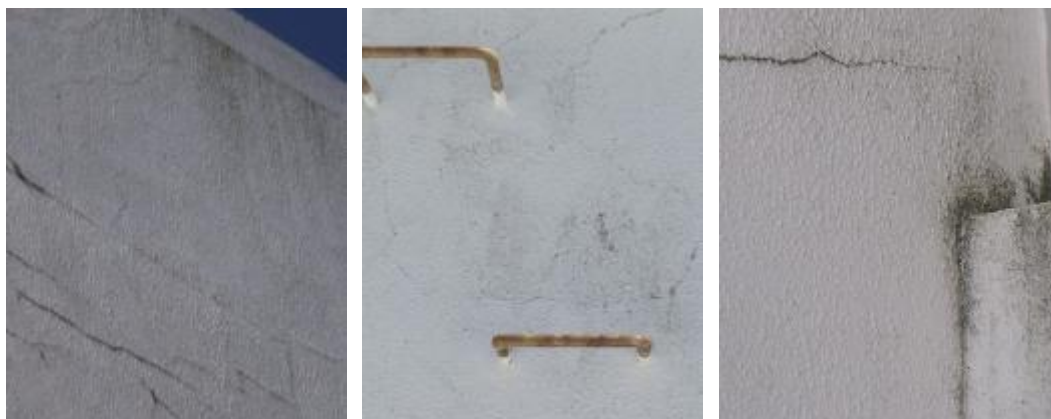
Fissuração diversa em paredes de alvenaria
